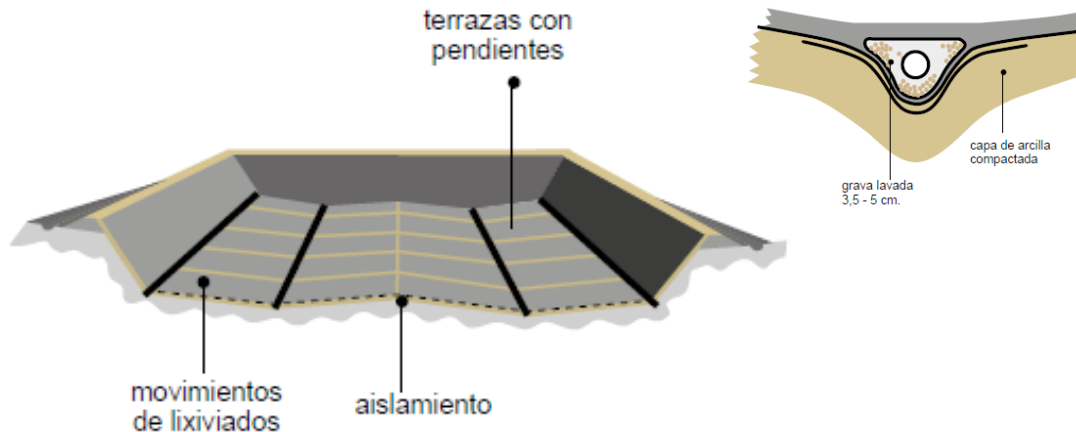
Red de drenaje de fondo dispuesta en el fondo de la zanja.
